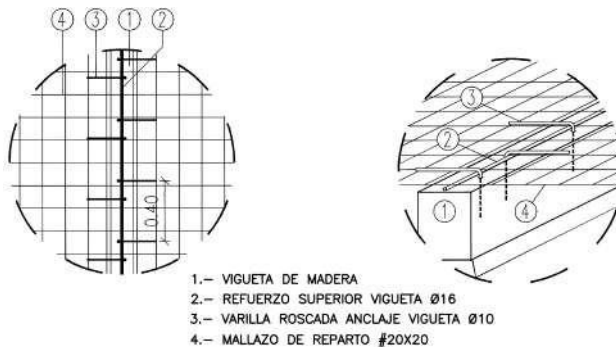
Detalle refuerzo vigueta con varillas roscadas ancladas a vigueta. Fuente propia
